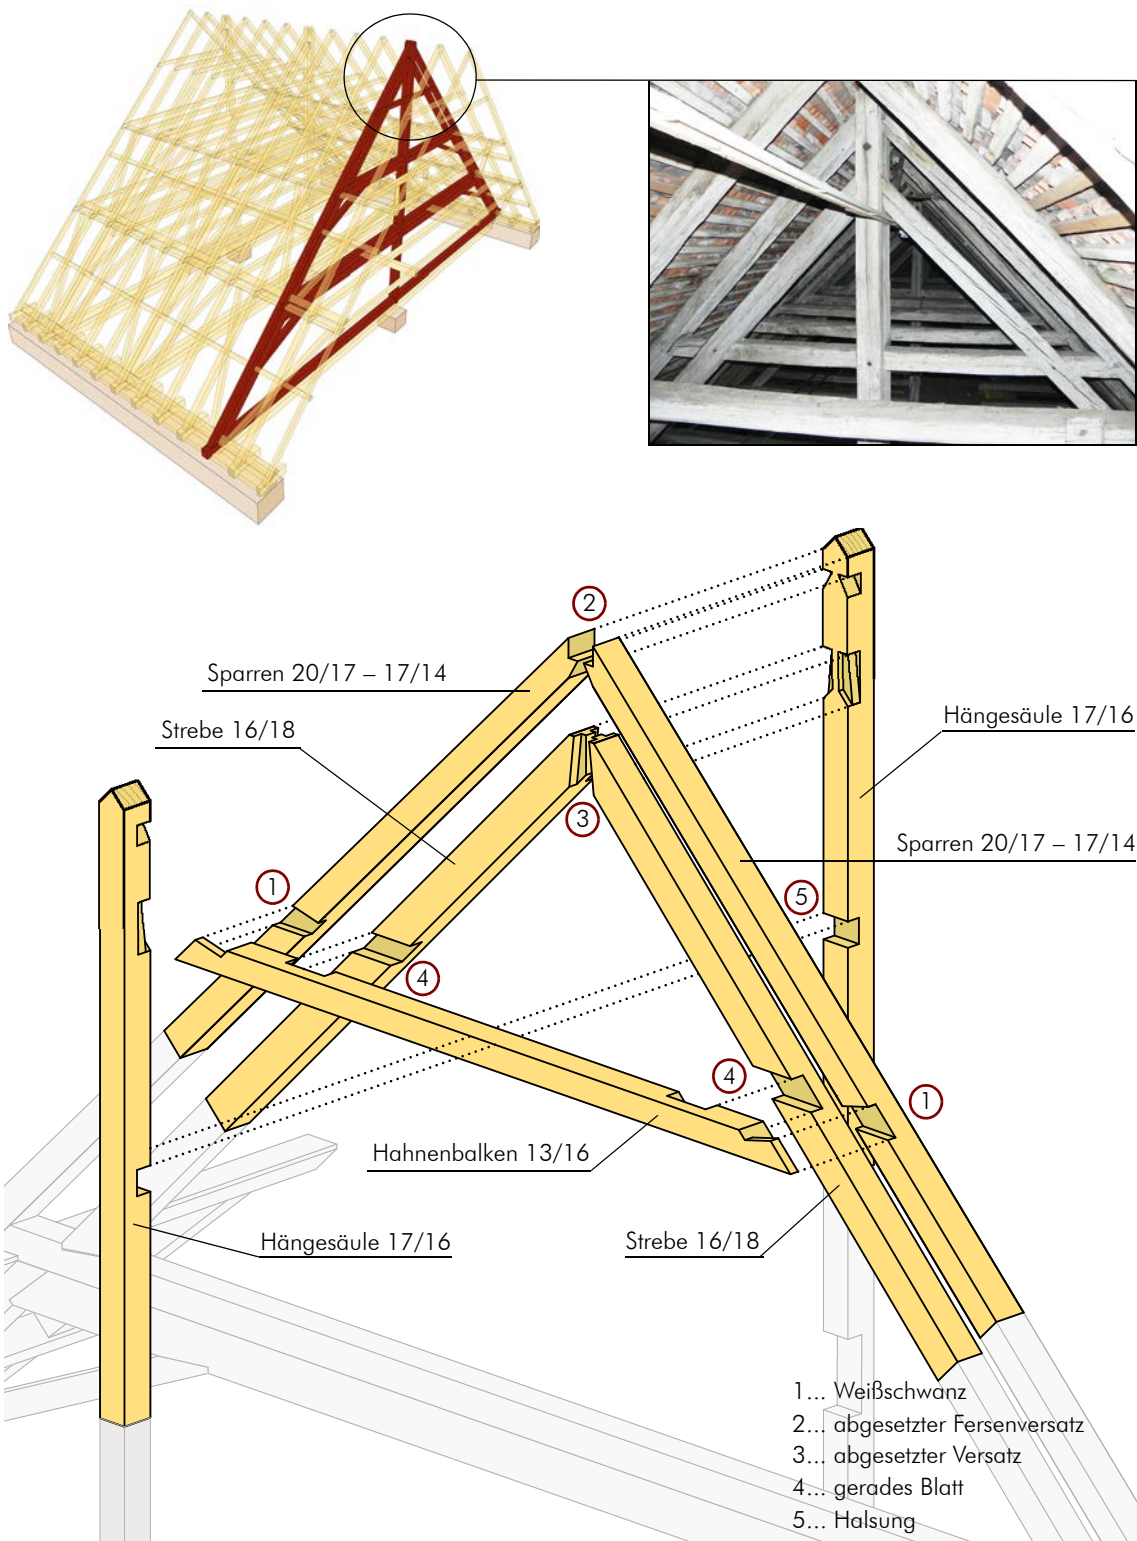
Bildliche Erörterung des Detailanschlusses Hahnenbalken – Sparren sowie des Firstpunktes (Abmessungen in [cm])
